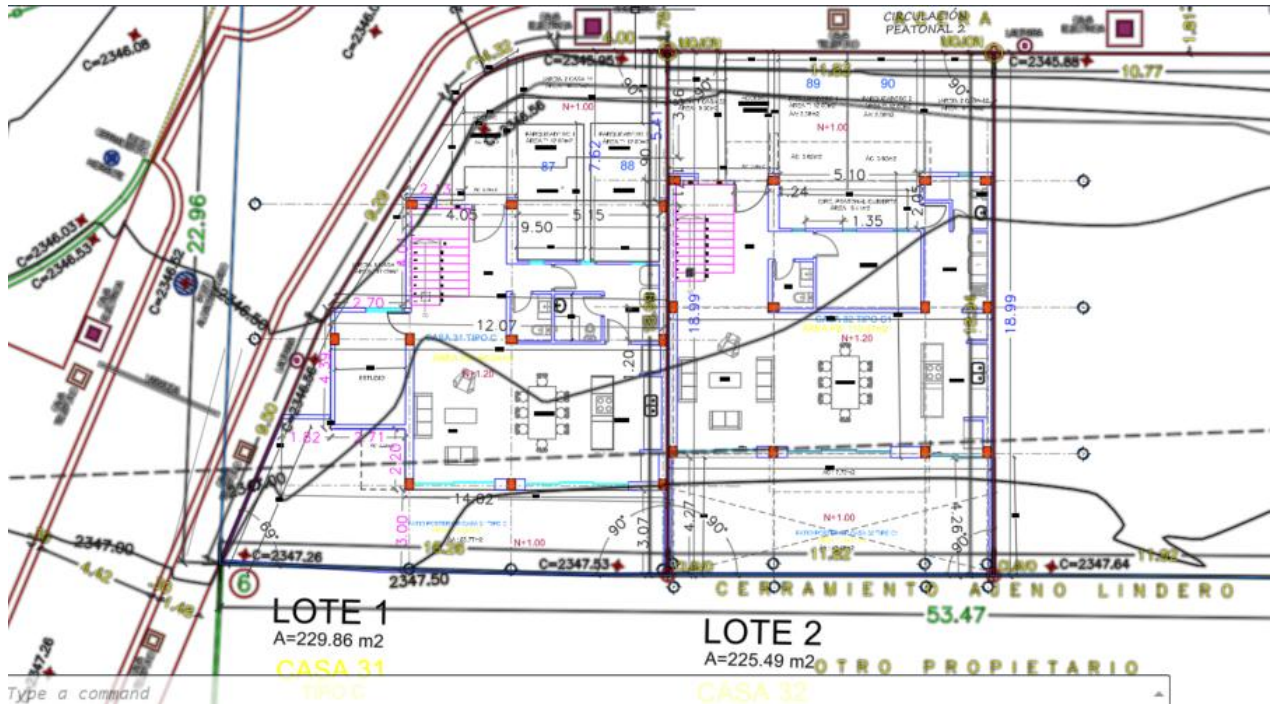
Plano de planta baja general del proyecto a desarrollar
